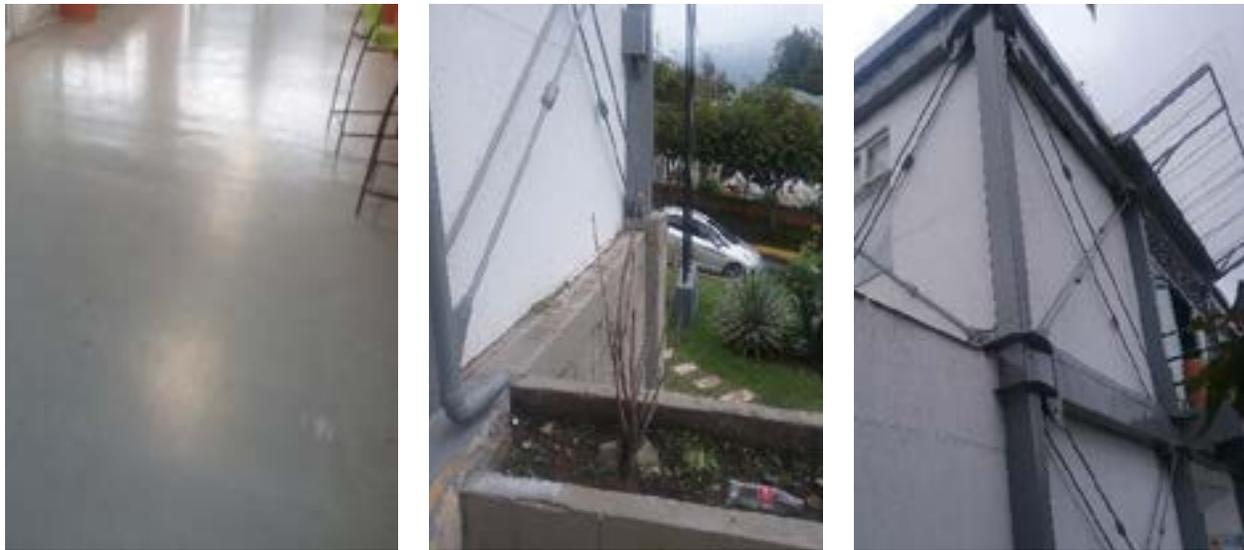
Sistema estructural, placa de contrapiso y fachada
